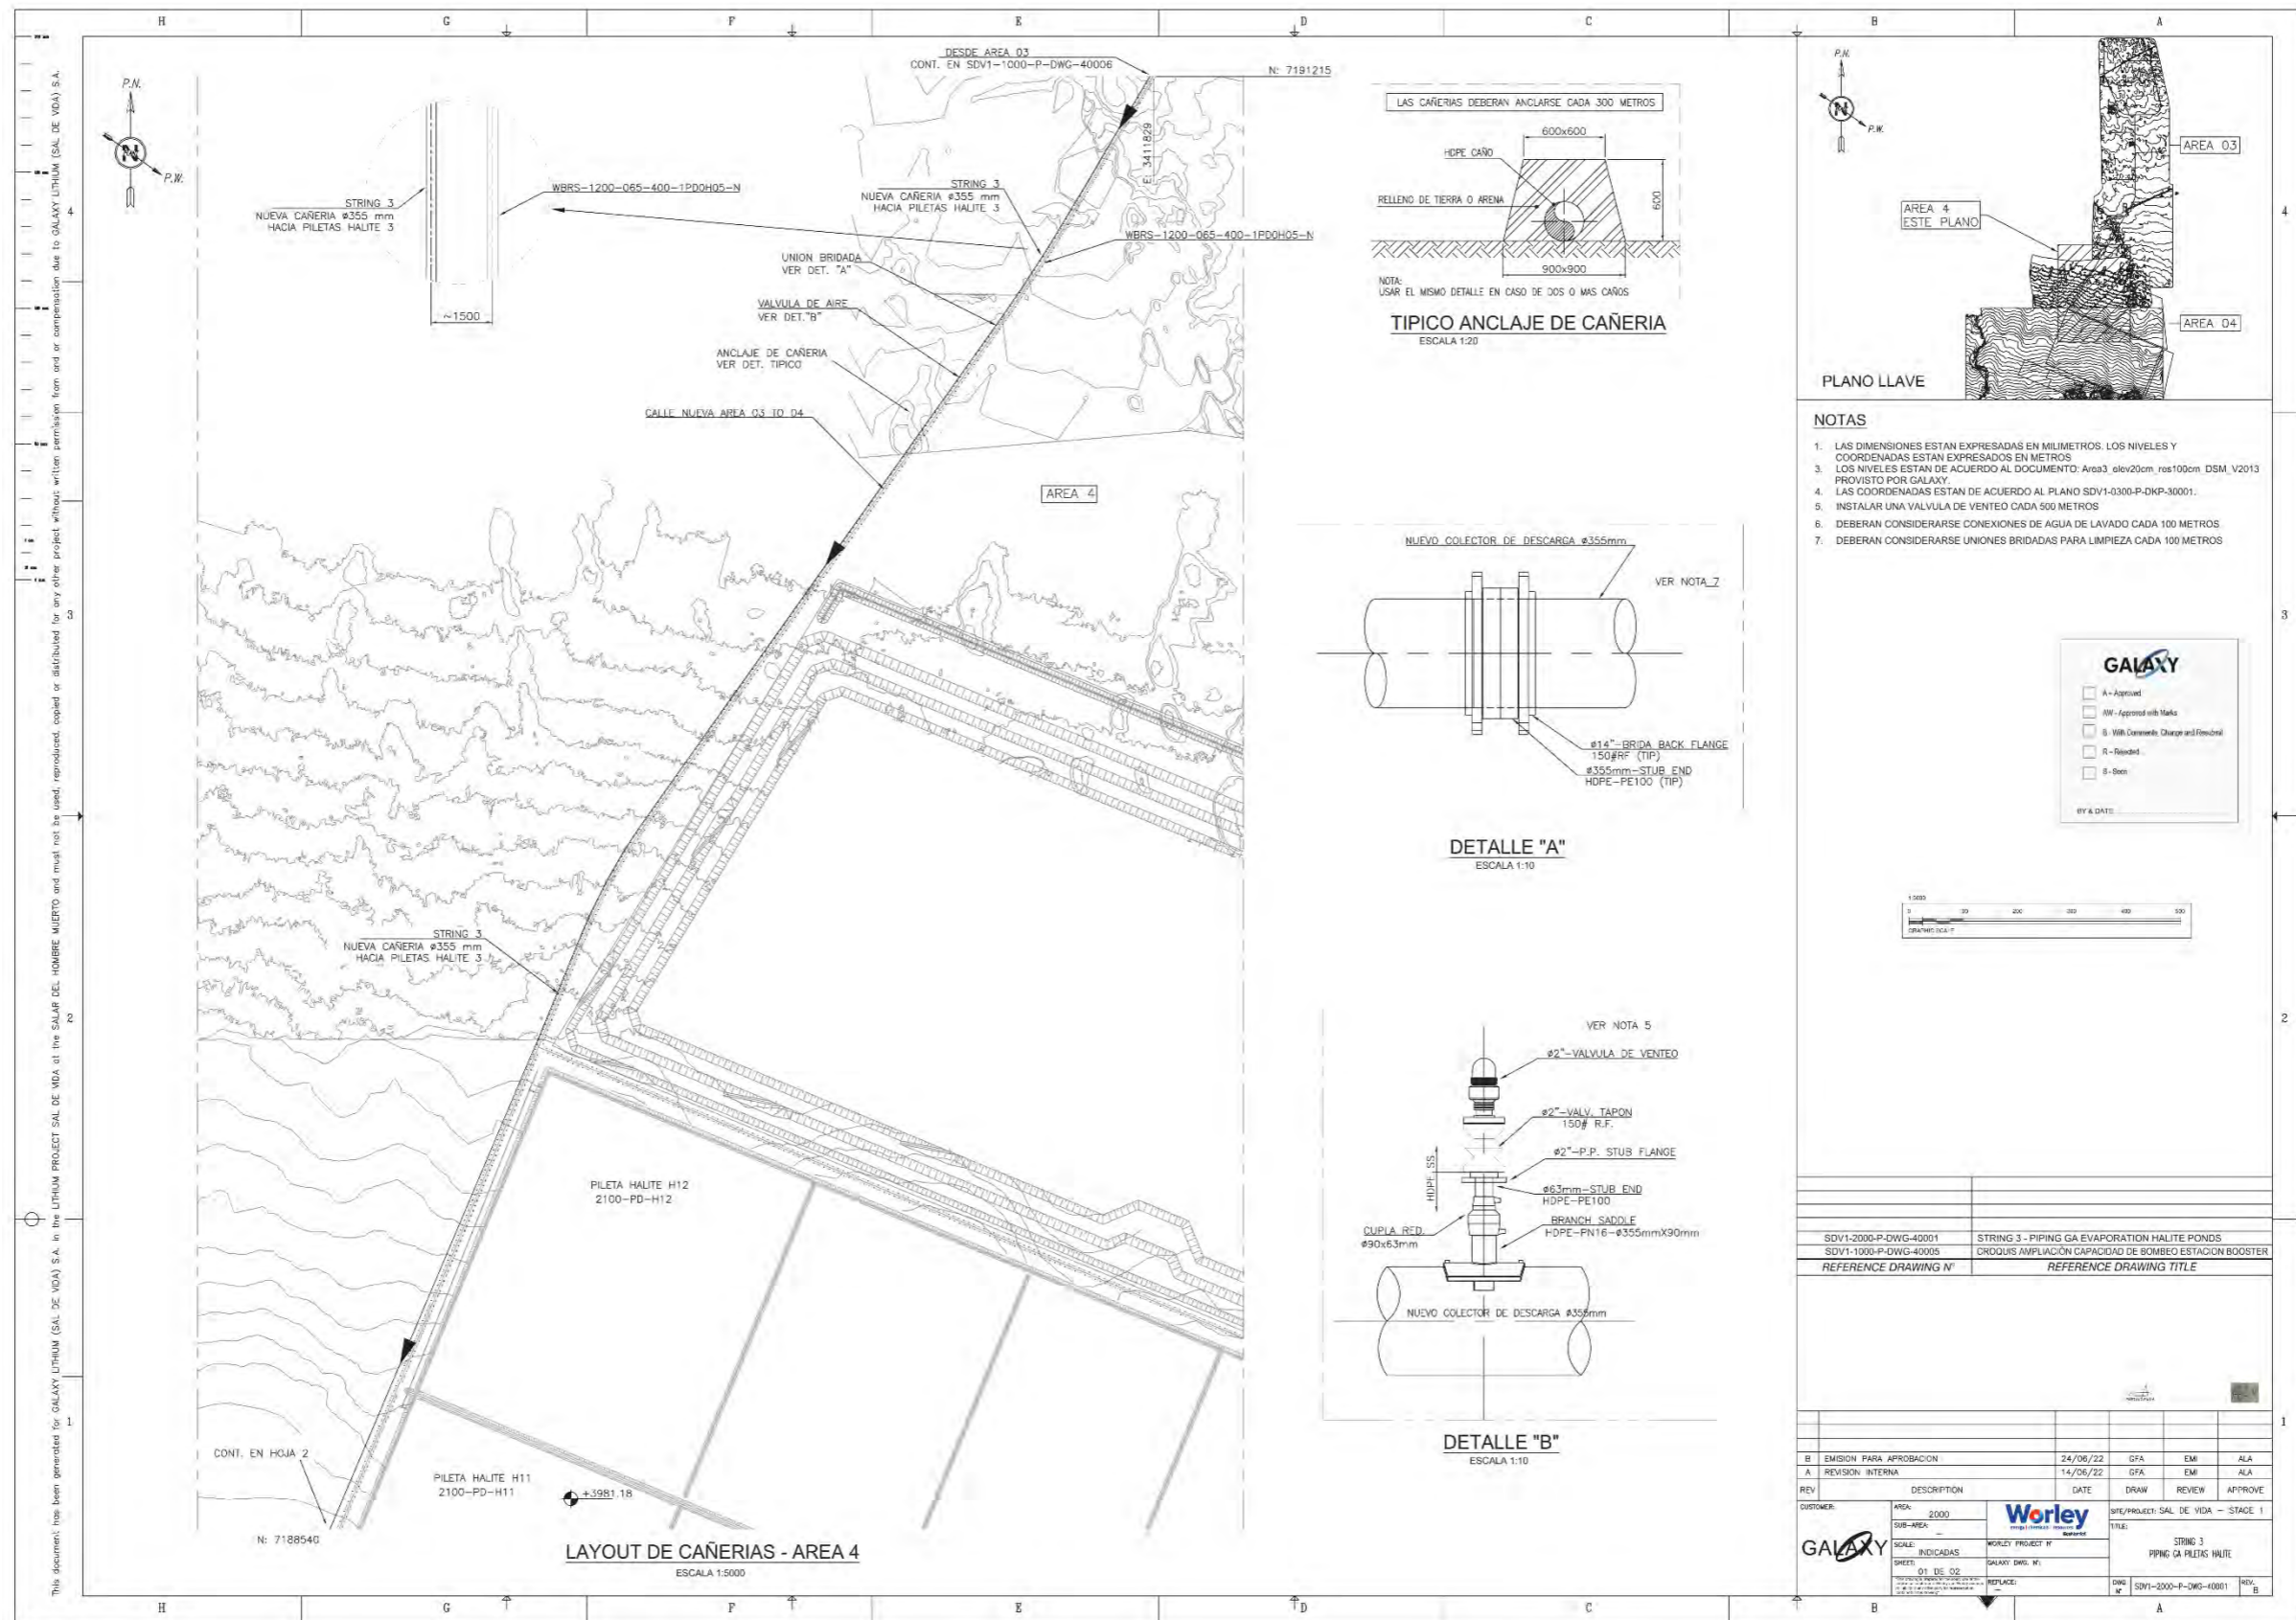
Plano con detalle del salmueroducto adicional hacia el String 3.
